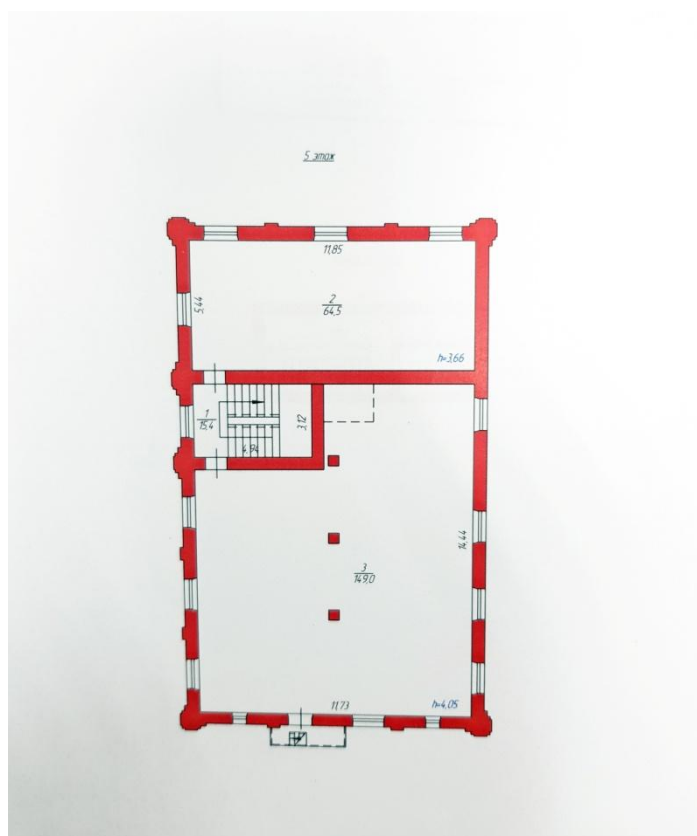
Здание мельницы и электросилового цеха. План пятого этажа. Источник: Технический паспорт нежилого здания здание мельницы
